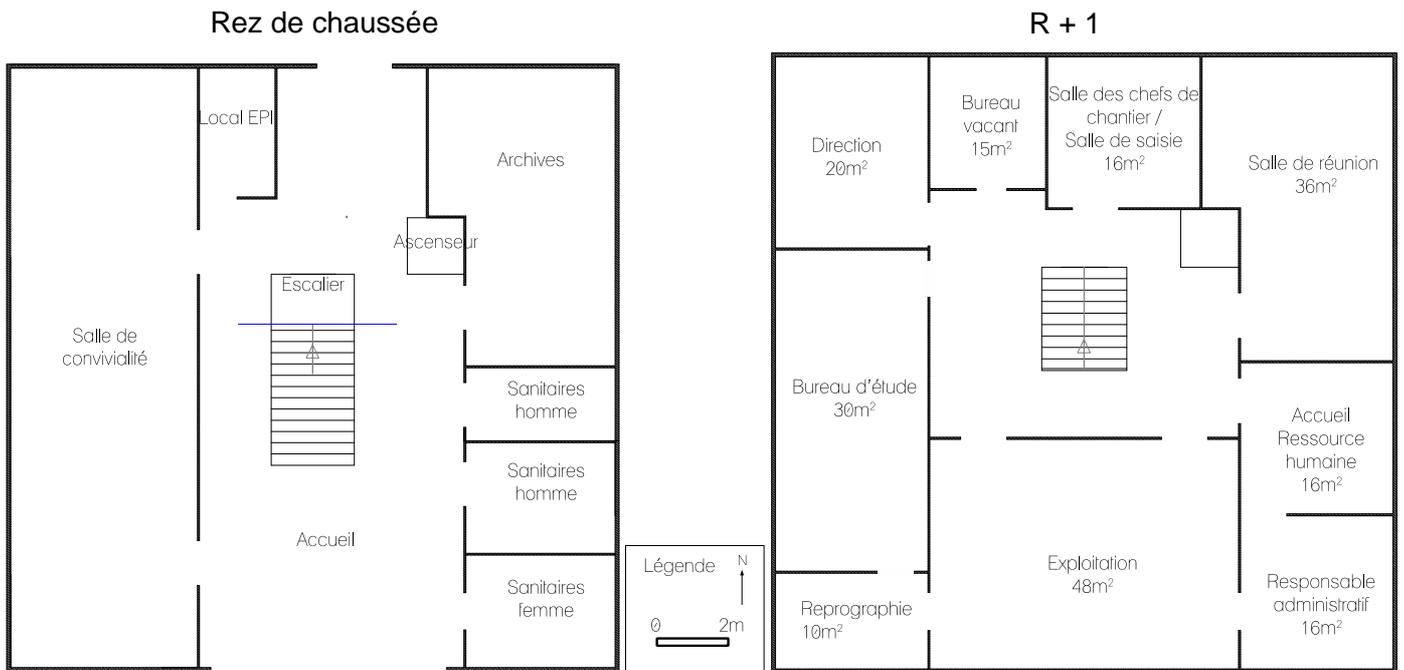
Plan des bureau R+1 et locaux commun Rez de chaussée (Eugénie Dauga, 2019)
